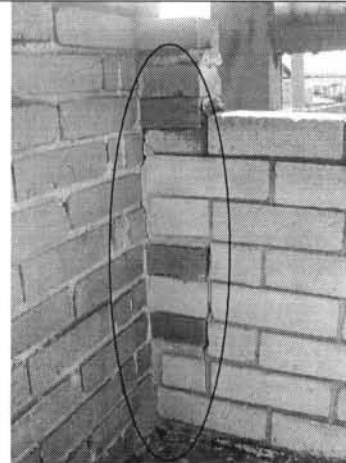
Dilatación de los ladrillos con el murete perpendicular.
